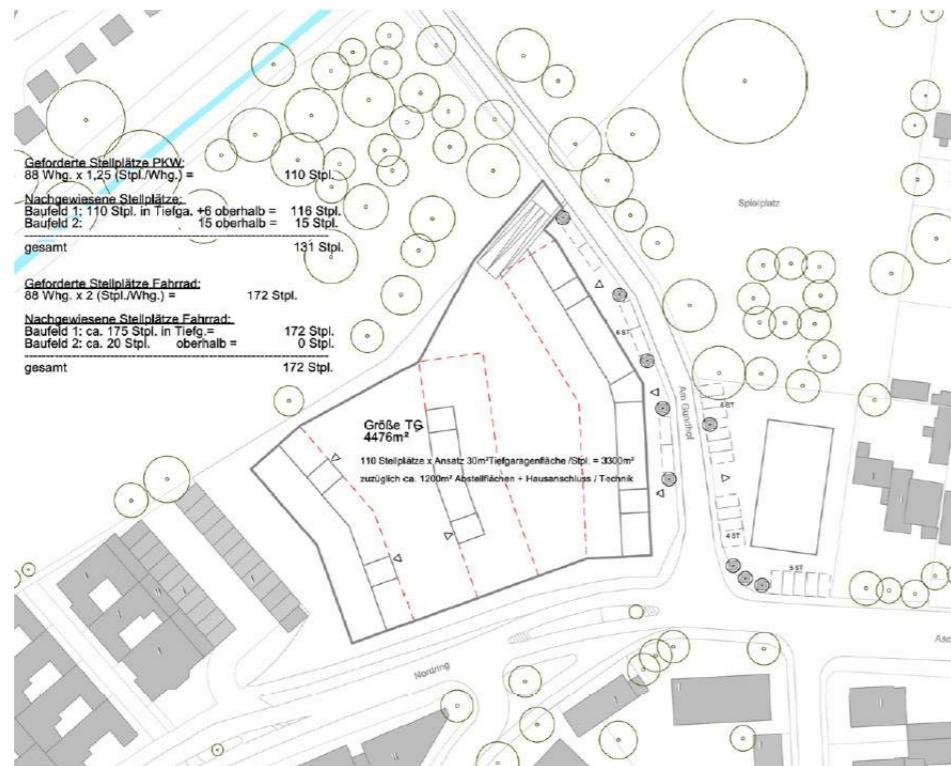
Planungsvariante 2 - Geschosswohnungsbau als Zeilenbebauung, geknickt
